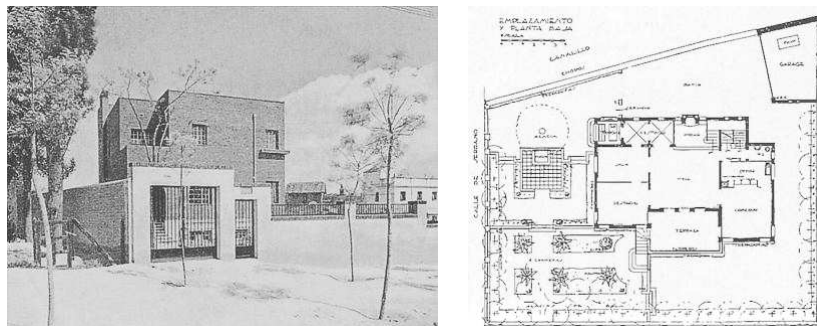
a|b Fotografía exterior y plano de planta del proyecto original de la casa para el Marqués Villora, en la calle Serrano de Madrid (1929).
